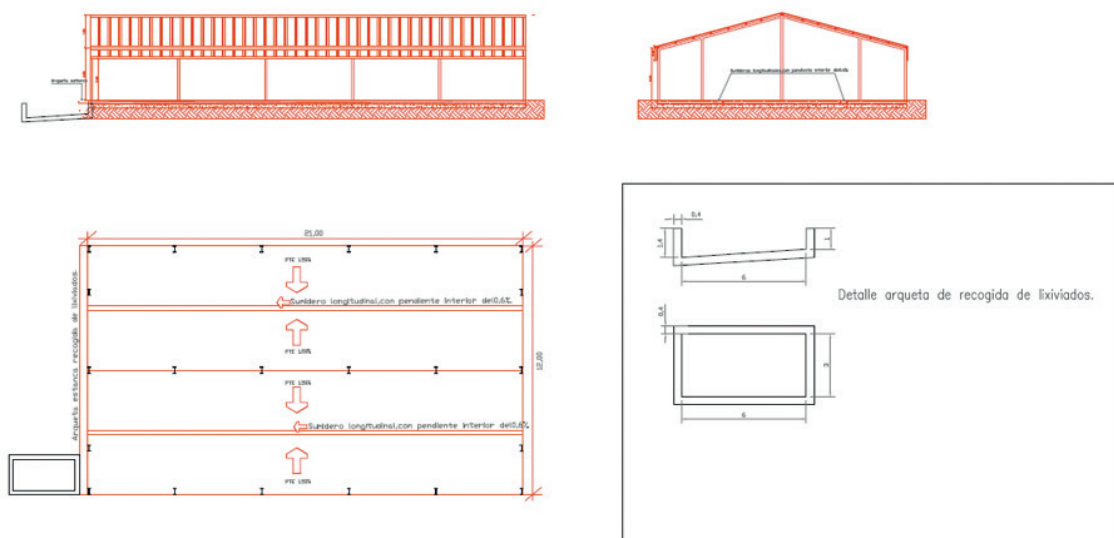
Plano detalle de sistema de recogida y retención de lixiviados.
